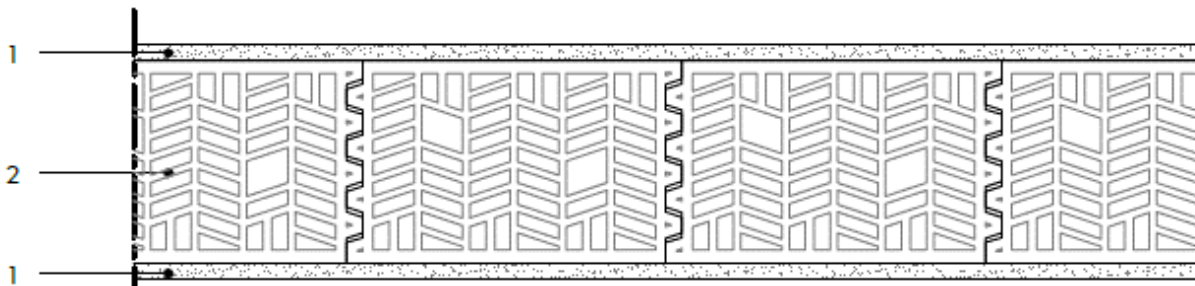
Pormenor construtivo da parede da habitação com a comunicação horizontal comum
